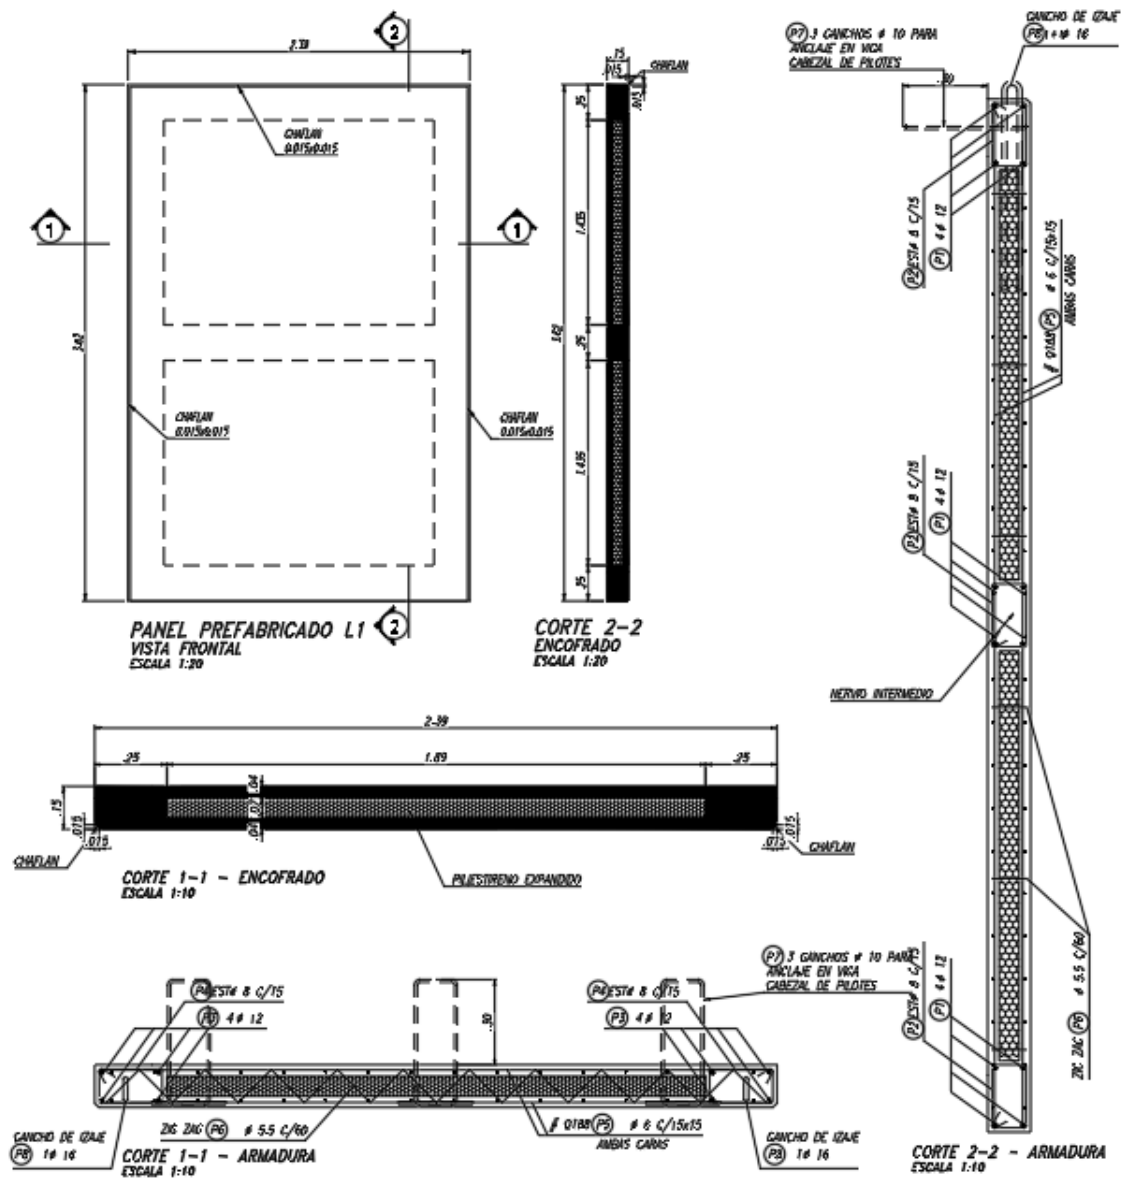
“Pantalla lateral de hormigón alivianada”
